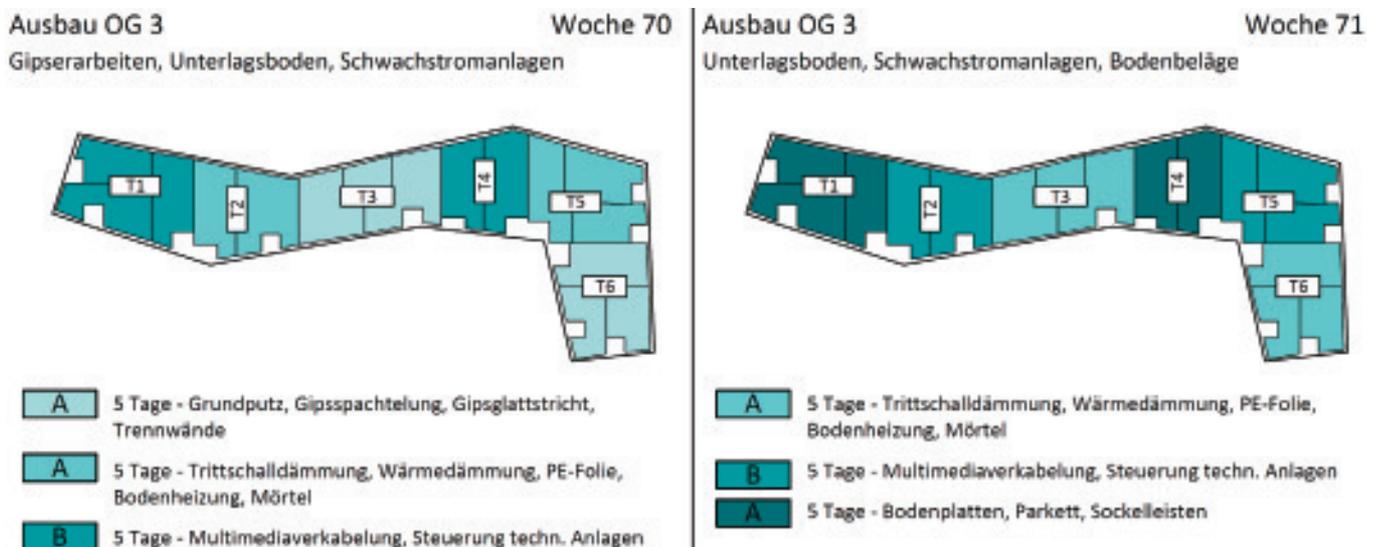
Ausschnitt aus dem Flächenmodell einer Hochbaustelle [4]
